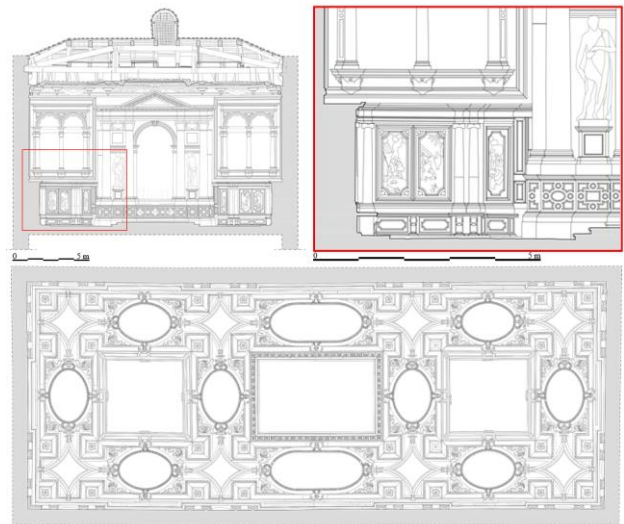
Alcune rappresentazioni digitali ottenute. In alto: una sezione trasversale con un dettaglio; sopra: la pianta rovescia
